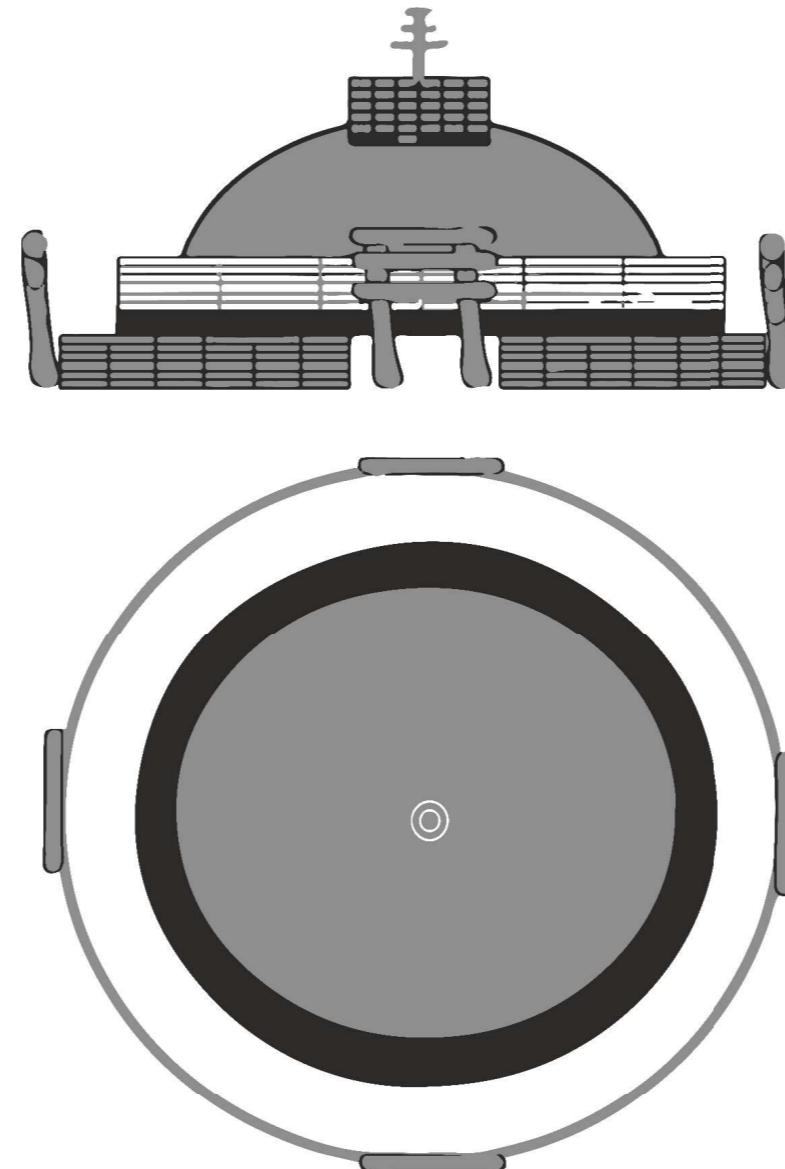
Planta y Sección estupa Madhya Pradesh en Sanchi, India
